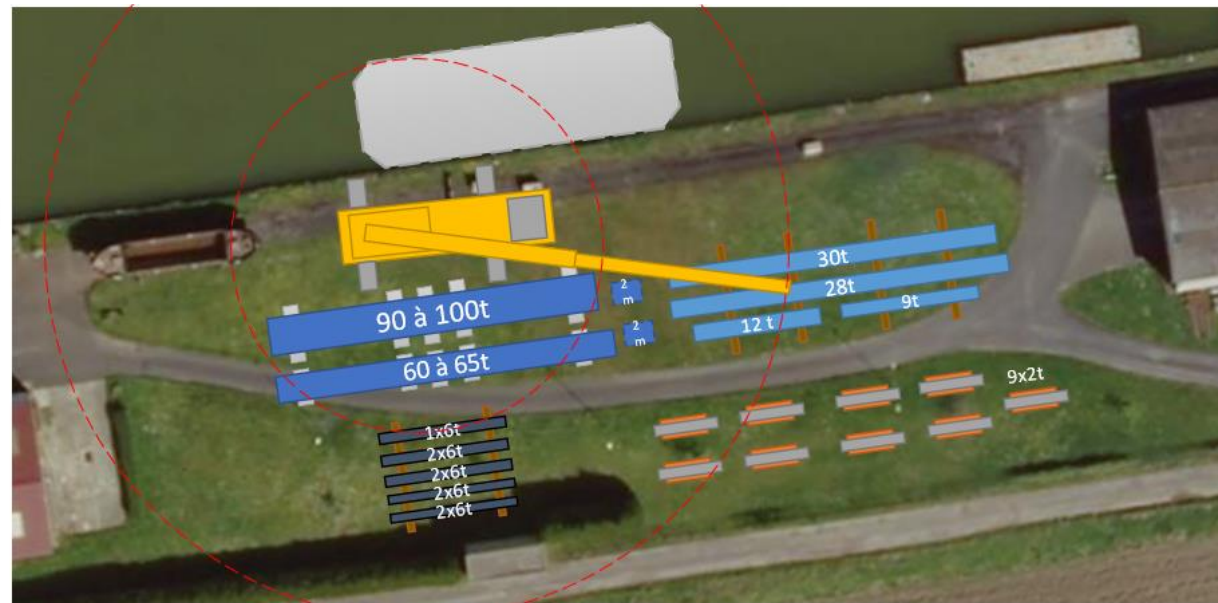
Schéma de principe d'implantation suggérée des équipements stockés (APS)
